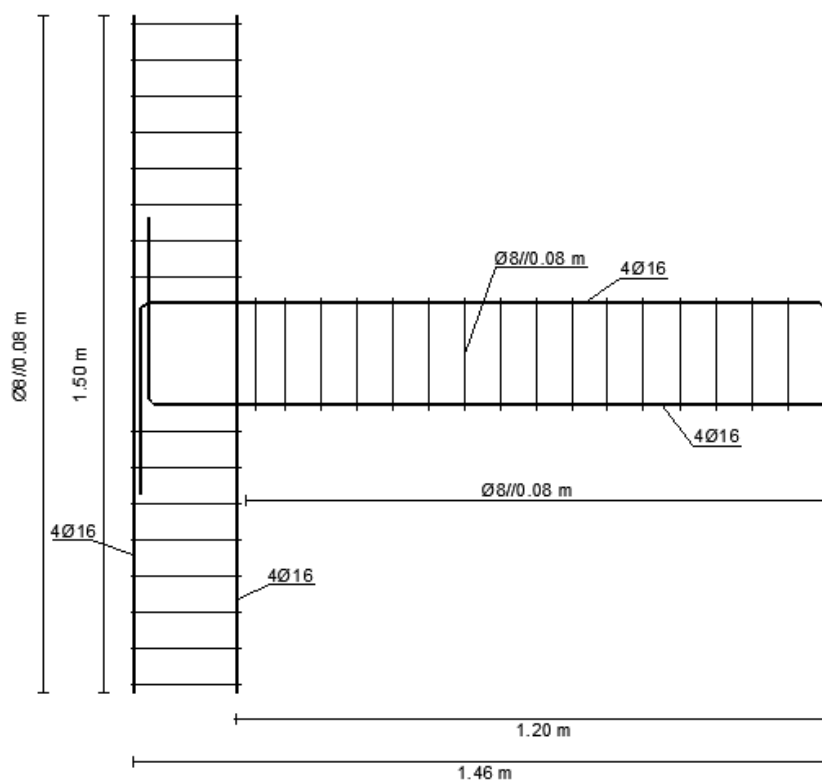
Corte longitudinal das peças P2, P4 e P5
